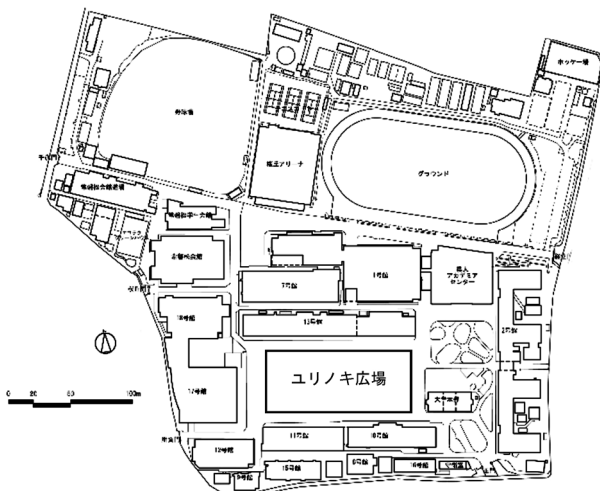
世田谷キャンパス平面図 (出典：施設部施設課)
